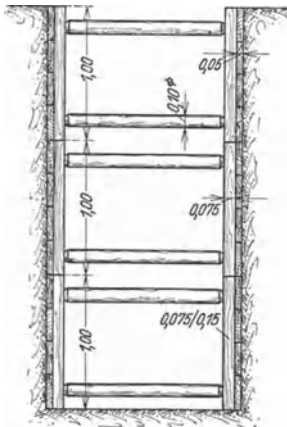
Baugrubenaussteifung mit horizontalen Dielen.
